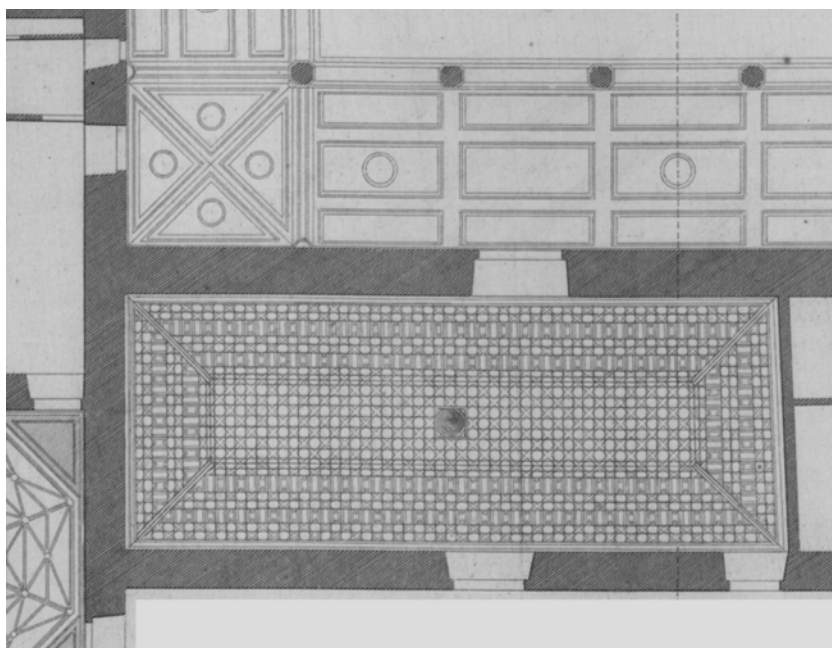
Palacio de los Duques del Infantado. Planta Primera, Salón de Cazadores
